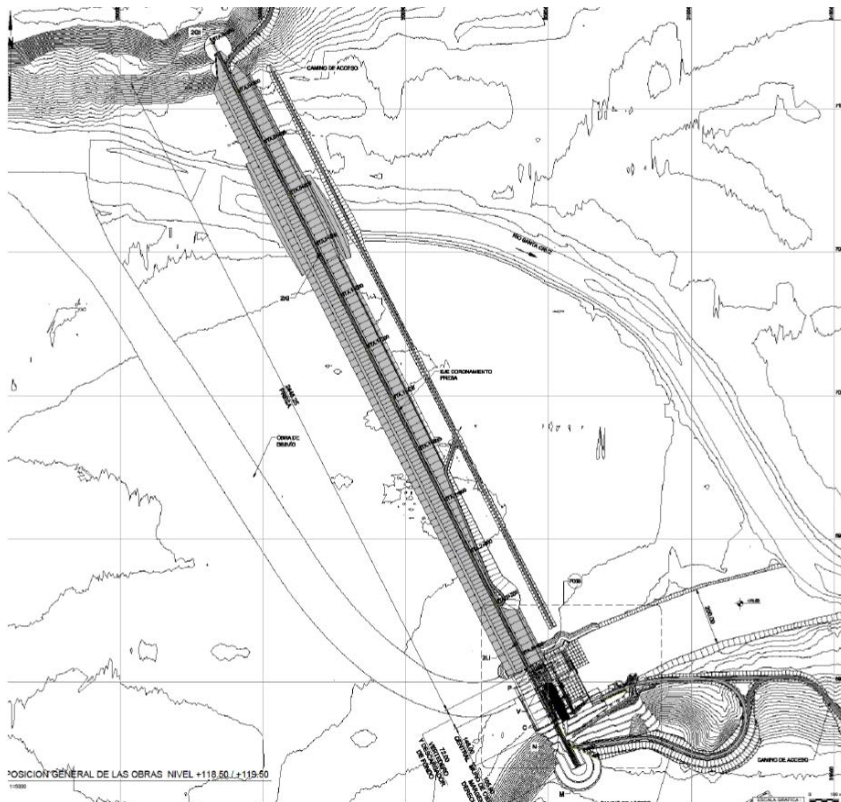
JC - Planta general de las obras (Fuente: Elaboración propia)
